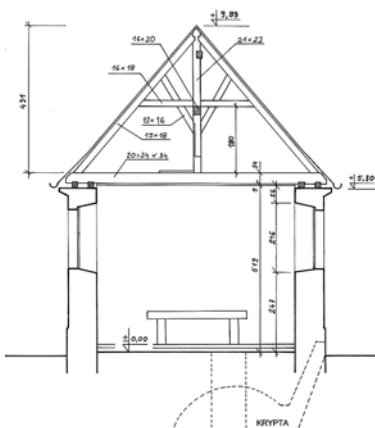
Konstrukcja storczykowa nad prezbiterium
